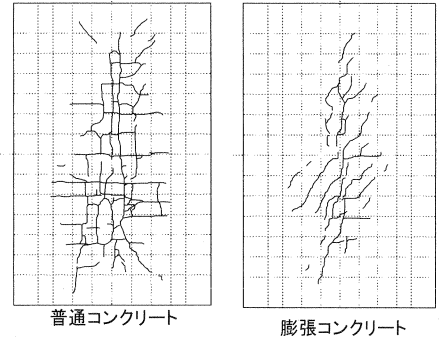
床版断面ひび割れ図 (2万回走行時)
